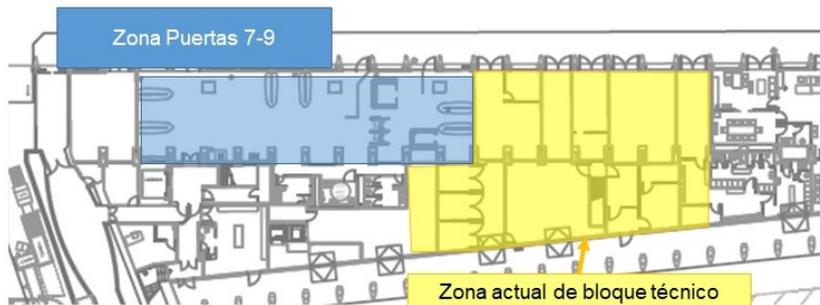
Sala de embarque entreplanta (puerta 6)
